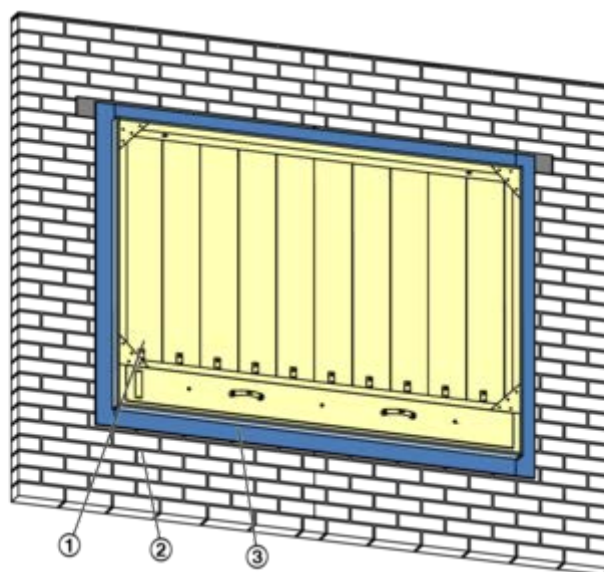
Esempio di installazione a secco senza malta EK-JZ in una parete piena, parete piena con intercapedine EI 120 S
